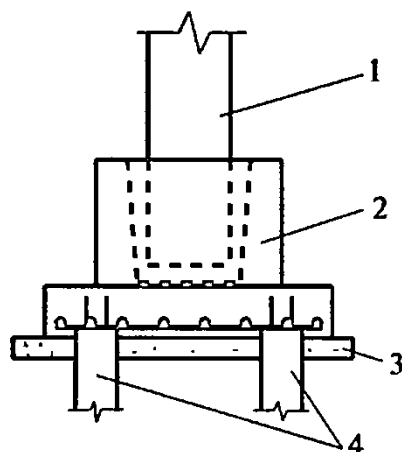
Свайный фундамент под сборную железобетонную колонну:
